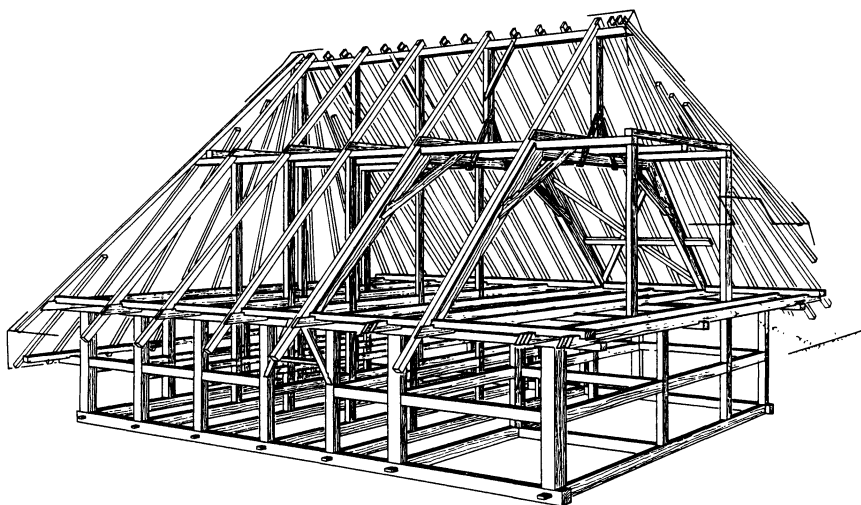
Tragwerk eines Höhenhauses mit Schwellenkranz, Firstständerkonstruktion im Stallteil und liegenden Stühlen mit abgefangenen Restfirstständern über dem Wohnteil.
